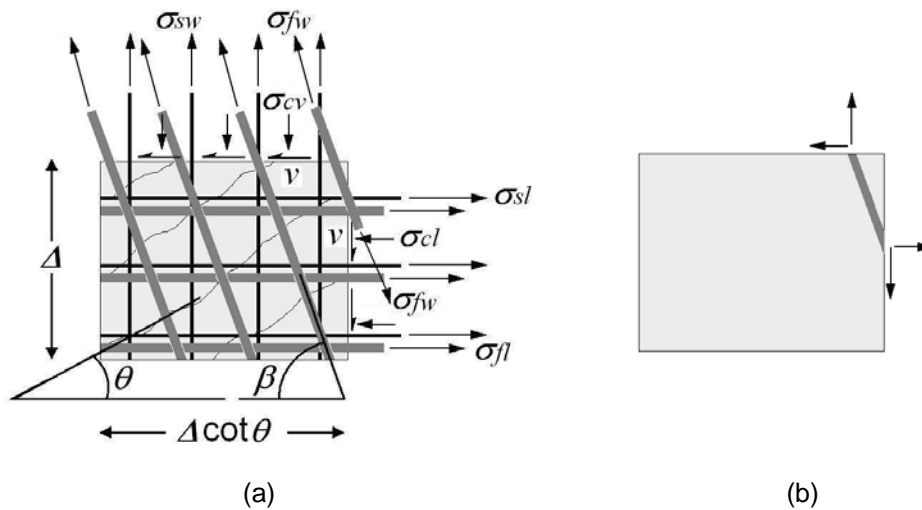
Elemento fissurado de viga de concreto armado com reforço externo de FRP
